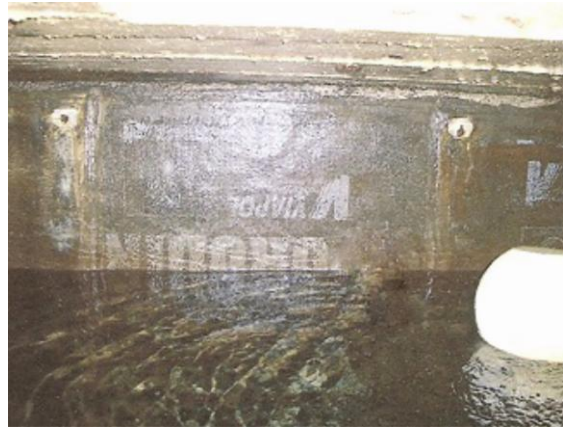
4.33 – Extrema deterioração da manta asfáltica.
